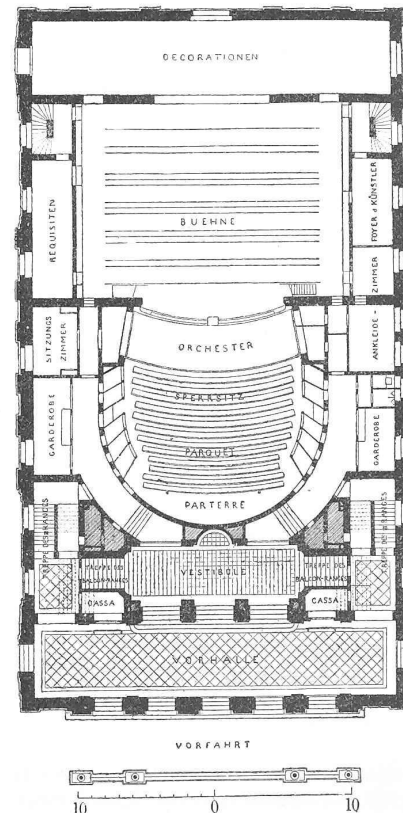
Grundriss des Parketts. — 1 : 500.
